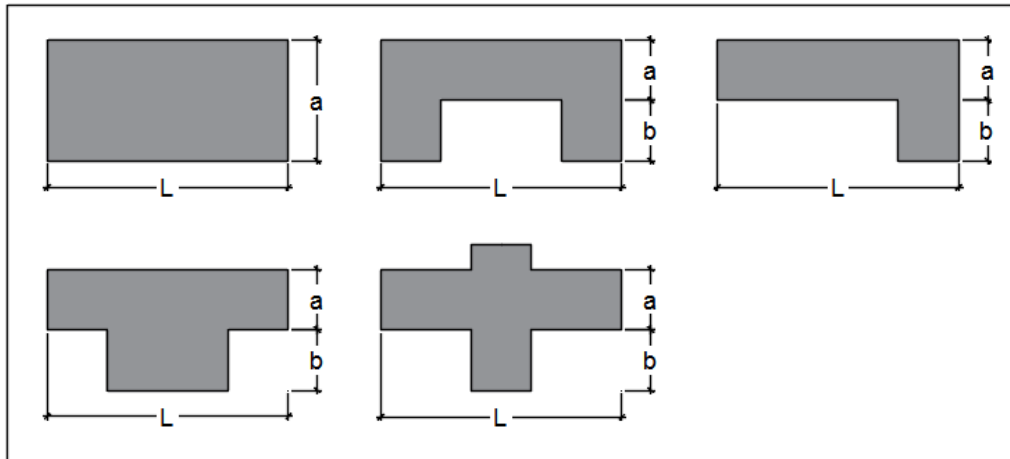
Configuración en planta de la estructura (Navia y Barrera, 2007)
